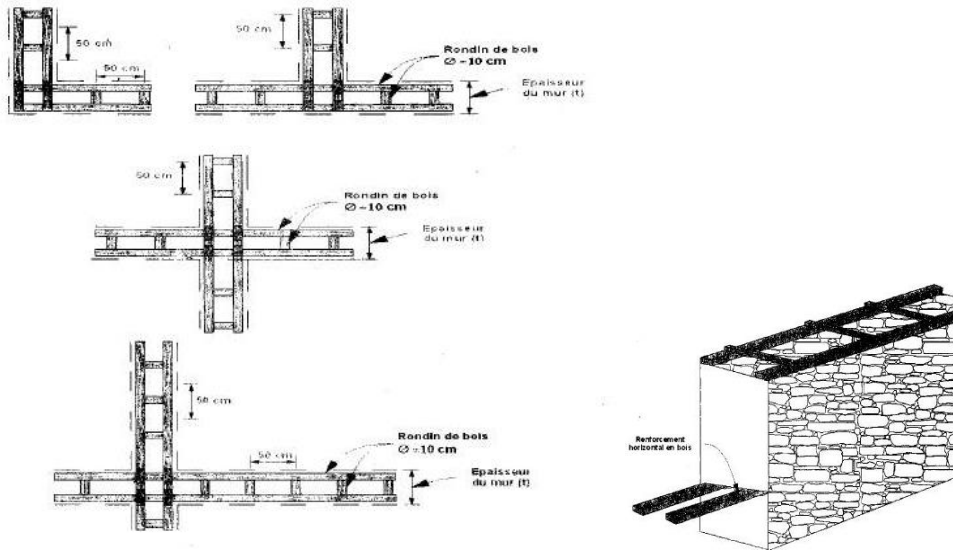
Refuerzo horizontal en madera, figura 34 de (Comité national des constructions en terre, 2013)
